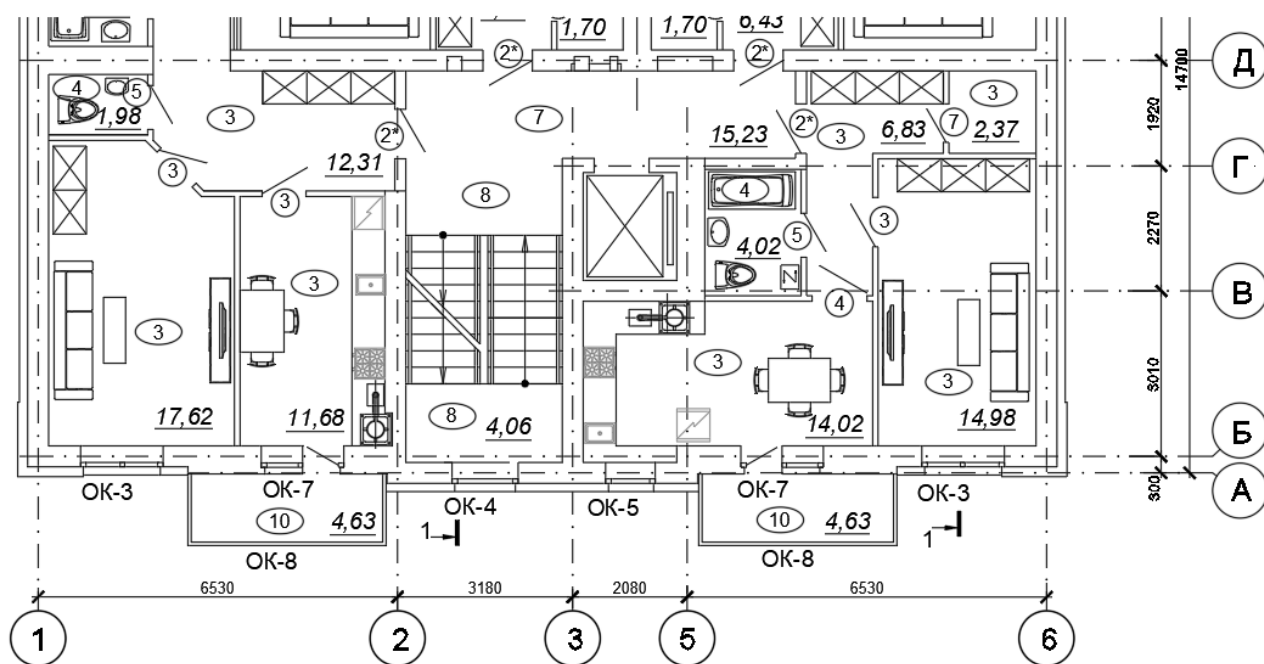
Фрагмент плану типового поверху цегляної будівлі
